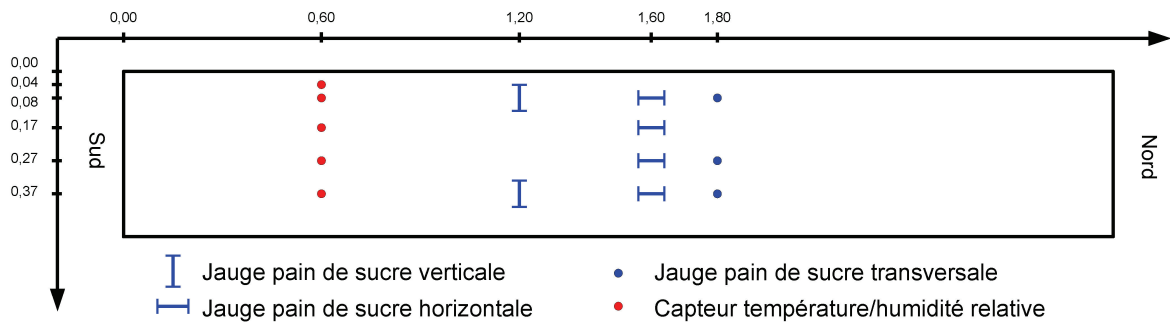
4 : plan d'instrumentation interne des poutres P2 à P6
